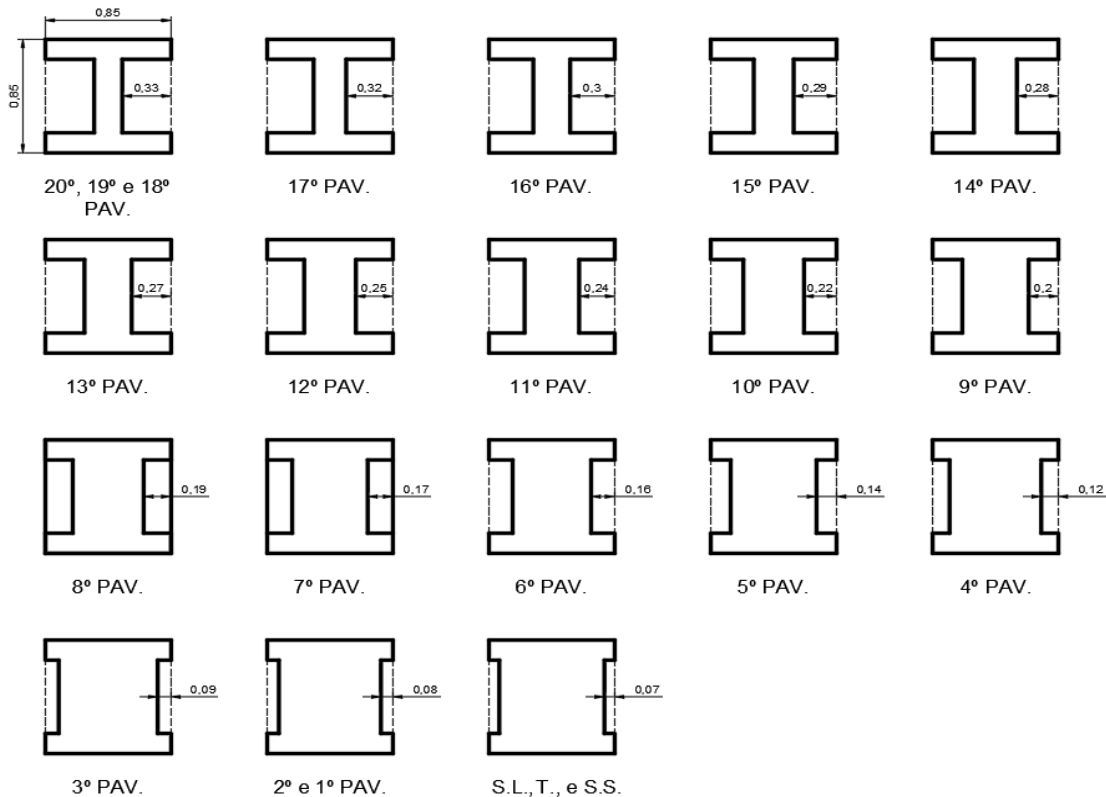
Escalonamento dos pilares (fonte: projeto arquitetônico executivo encontrado na biblioteca da FAU.USP)
